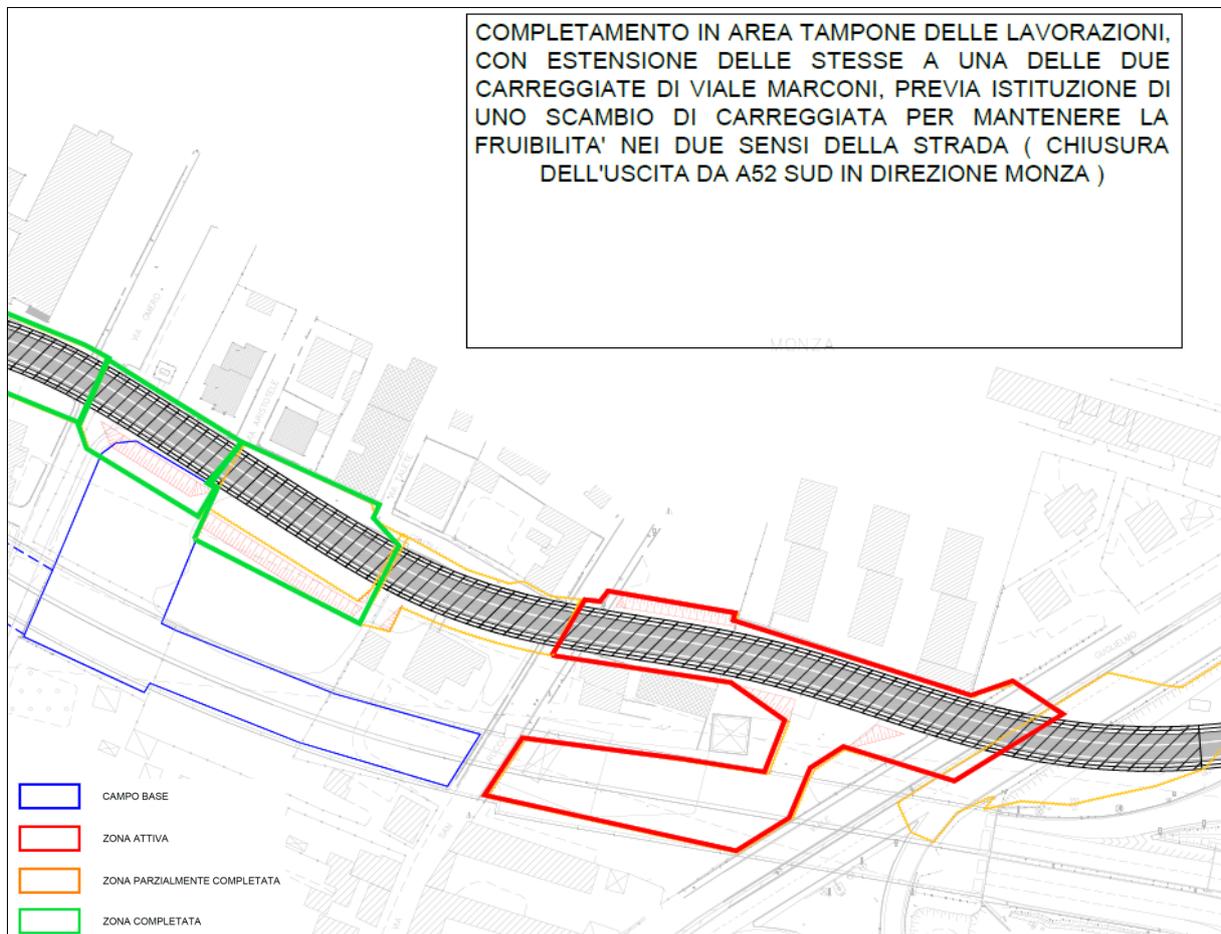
Fasi realizzazione copertura galleria del Piano di Sicurezza di progetto illustrativo della fase F di scavo della galleria
